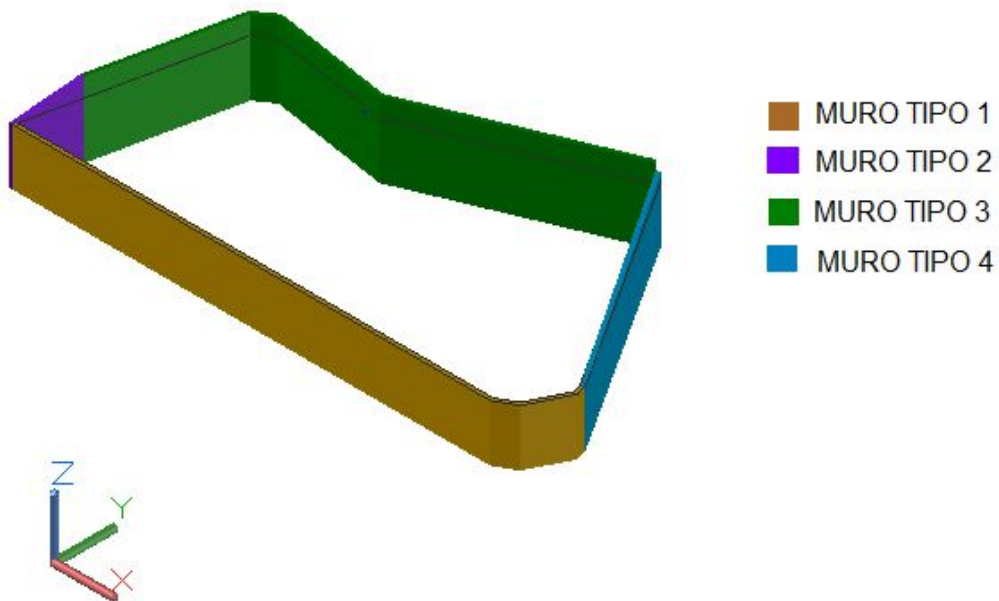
Vista 3D de los muros tipo. AutoCAD Civil 3D
